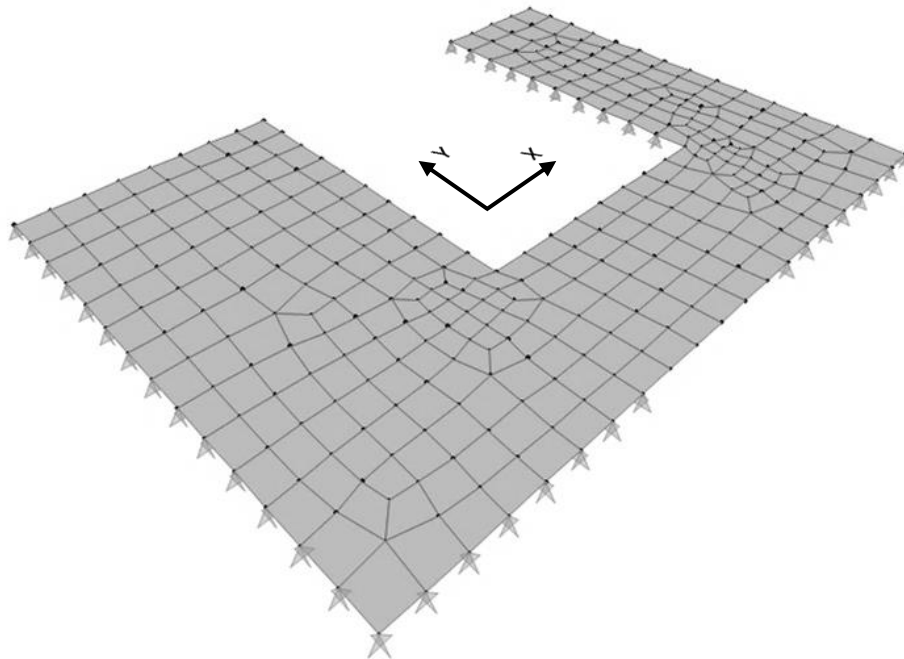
Vista del modelo estructural de la losa maciza.
